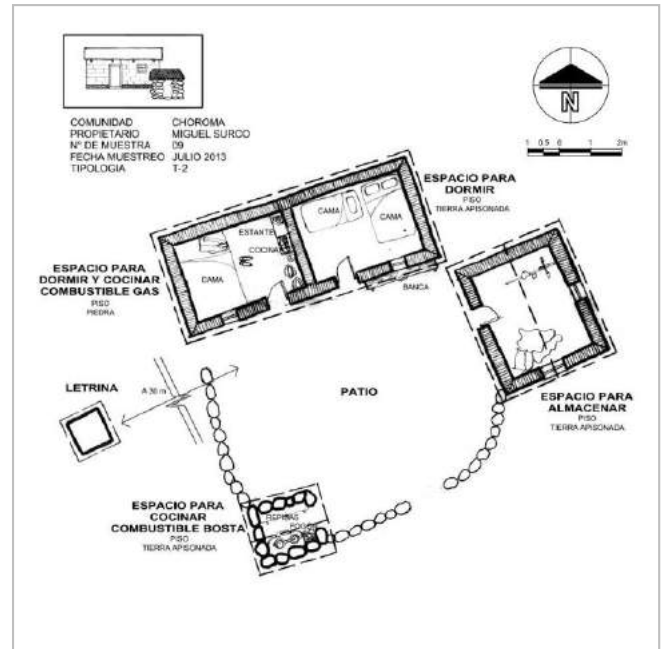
Planta de una vivienda autóctona (Fuente: Elaboración propia)
